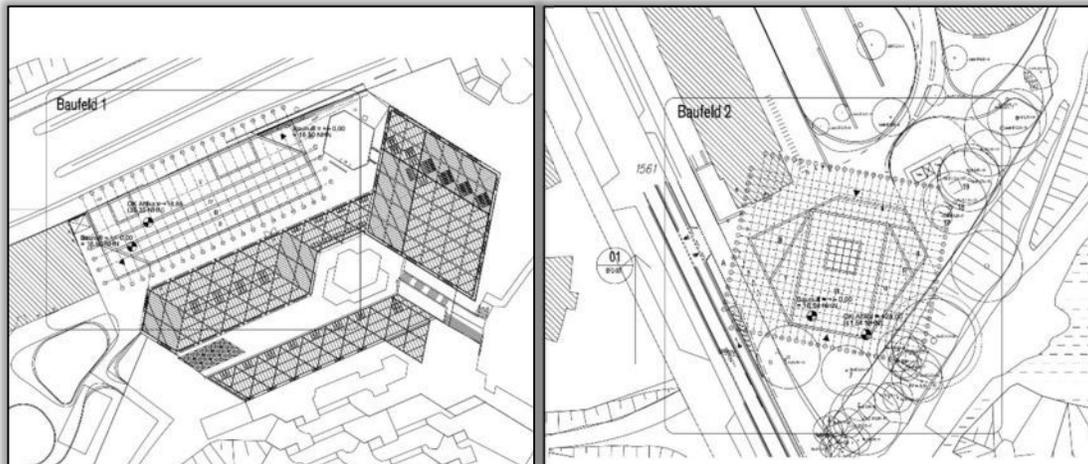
Ausschnitte der zwei Baufelder innerhalb des Lageplans zur geplanten Flächennutzung im Bereich des Bebauungsplan-Entwurfs Neustadt 51 / St. Pauli 46 „Erweiterung Bucerius Law School“ (Quelle: Kraus Schönberg Architekten, Stand: 21.02.2022).
